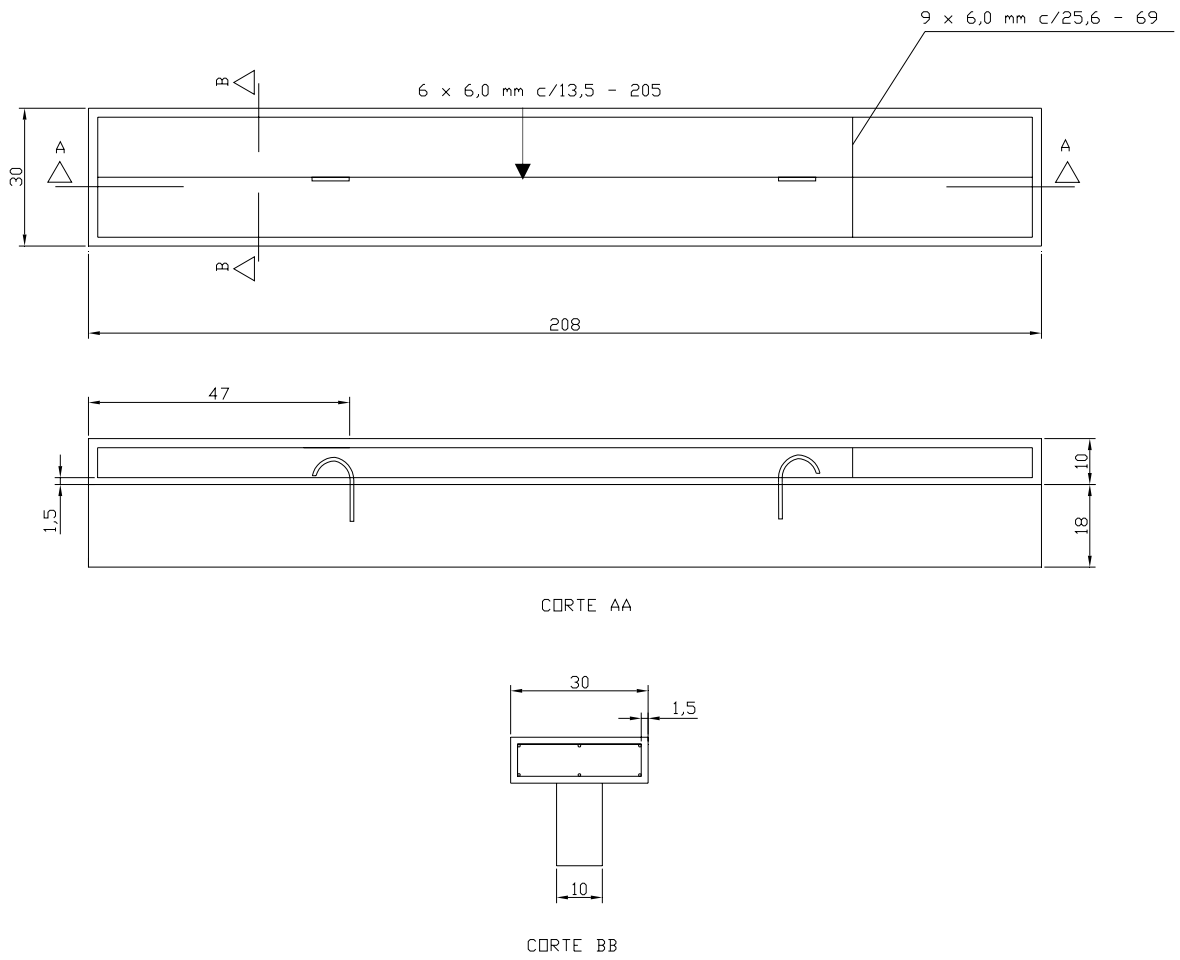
Viga mista com 2 conectores de 8,0 mm
